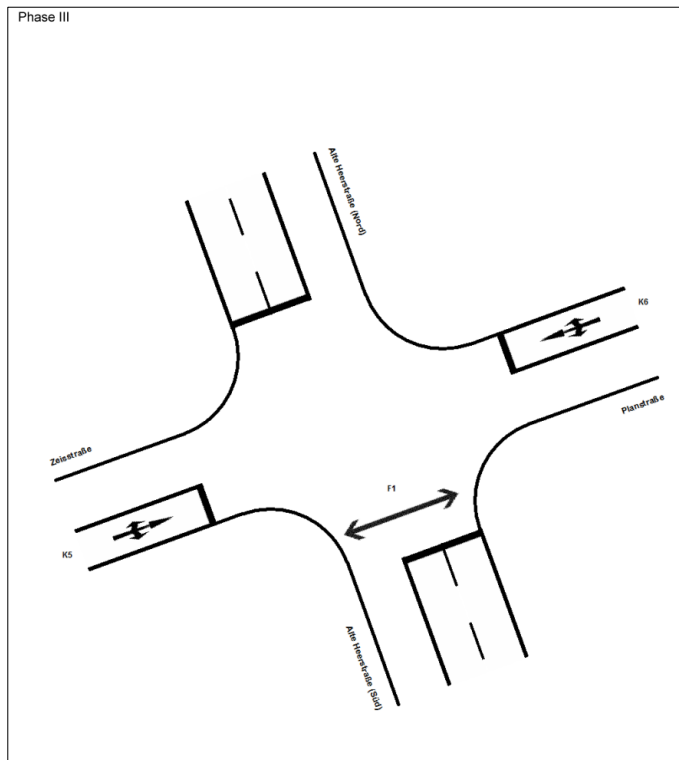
Phase 3 am Knotenpunkt Alte Heerstraße (B3) / Zeissstraße / Planstraße
